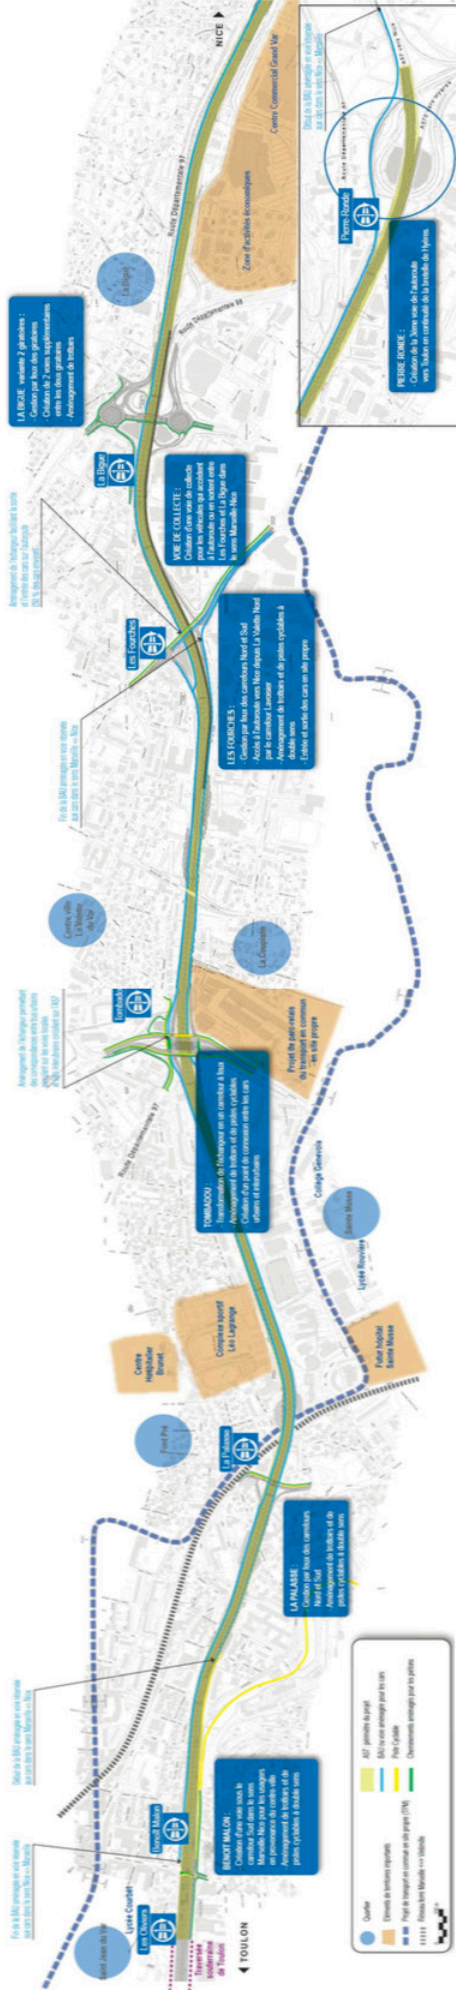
Vue en plan du scénario « Elargissement avec circulation facilitée des cars »
